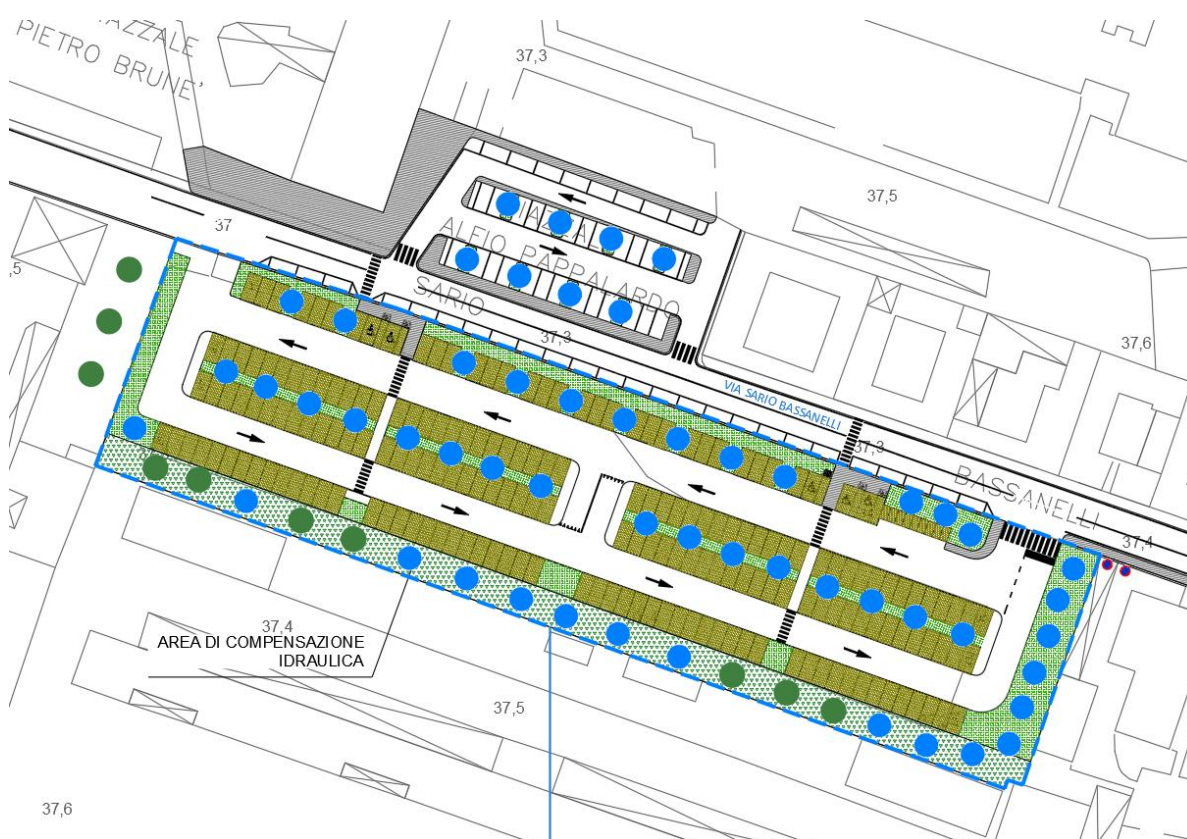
Parcheggio via Bassanelli e Largo Pappalardo (PFTE)
